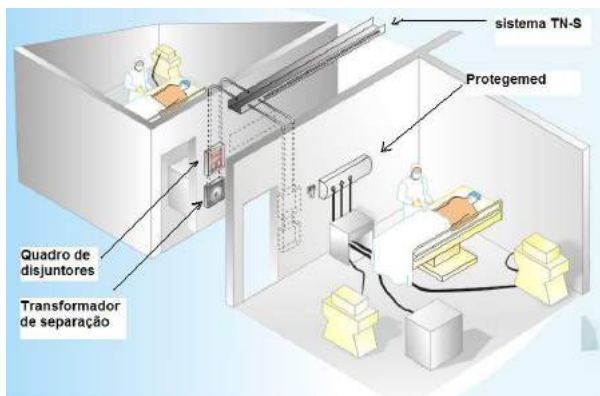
Desenho da parte de um centro cirúrgico e de uma sala de cirurgia mostrando onde o Protegemed está instalado [3].
